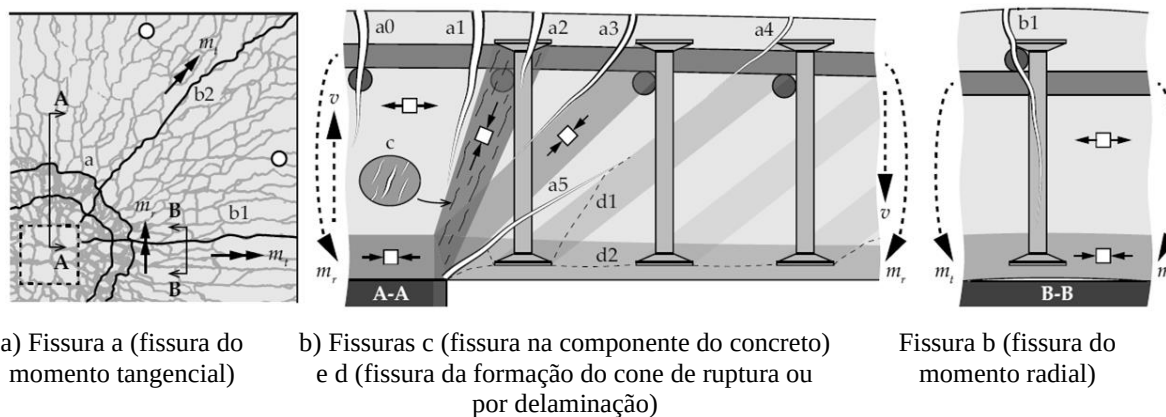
Desenvolvimento da fissuração em lajes lisas com armadura de cisalhamento (adaptado de Brantschen, 2016)
